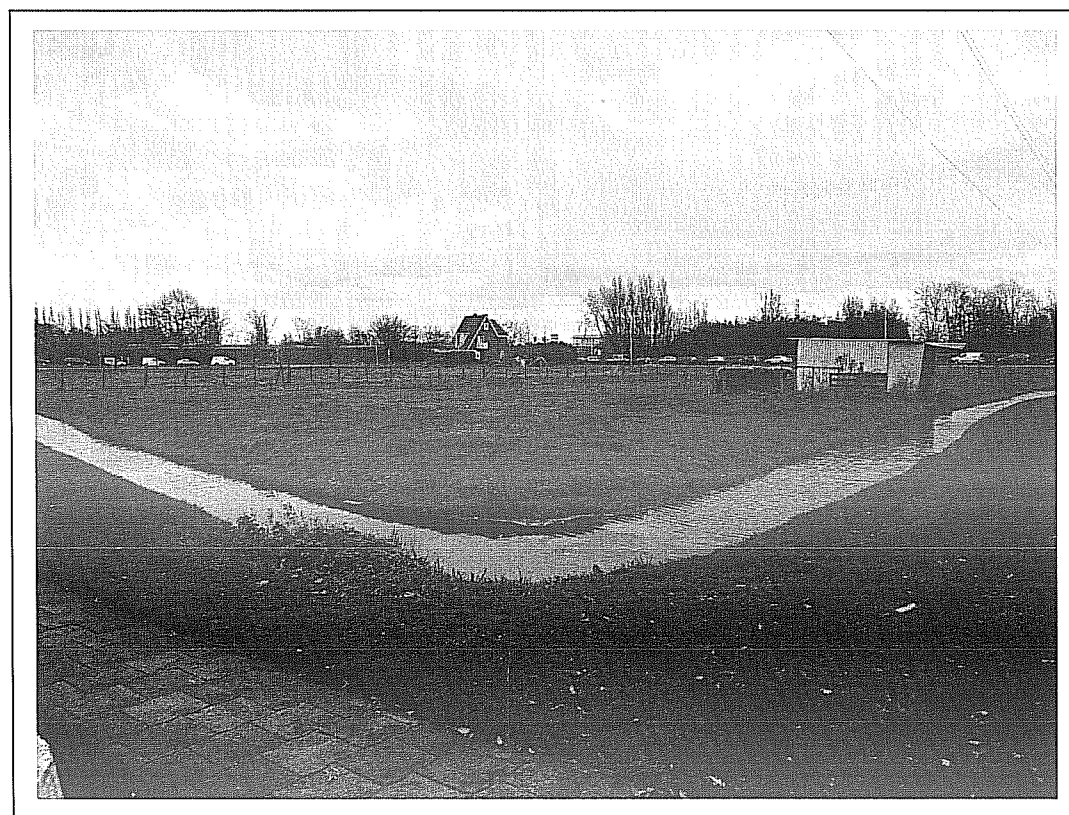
Deels te dempen hoek van sloot voor de geplande aanleg bypass
